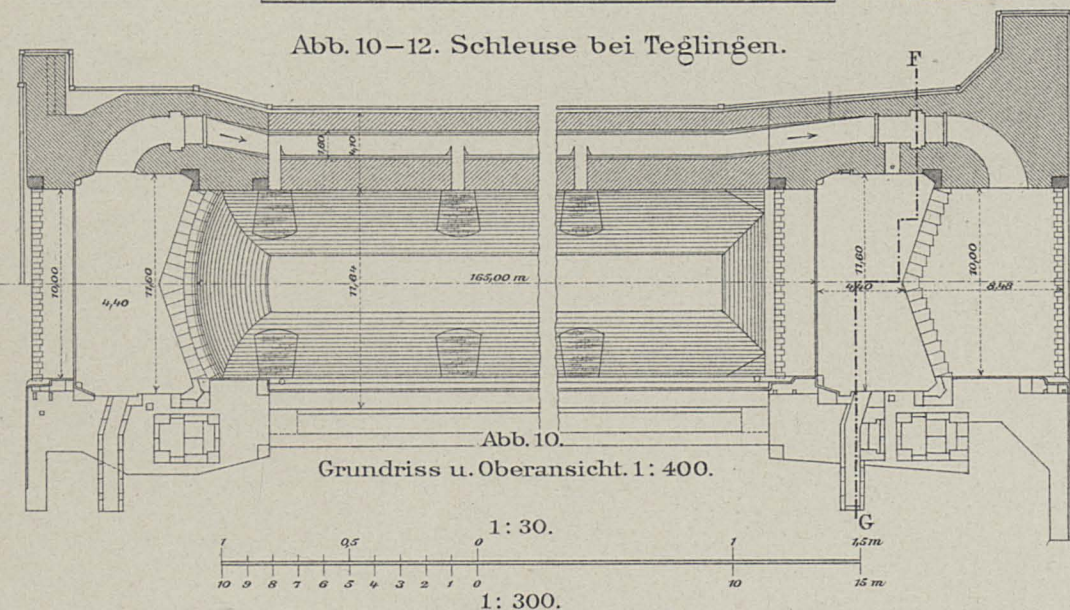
Grundriss u. Oberansicht. 1: 400.
